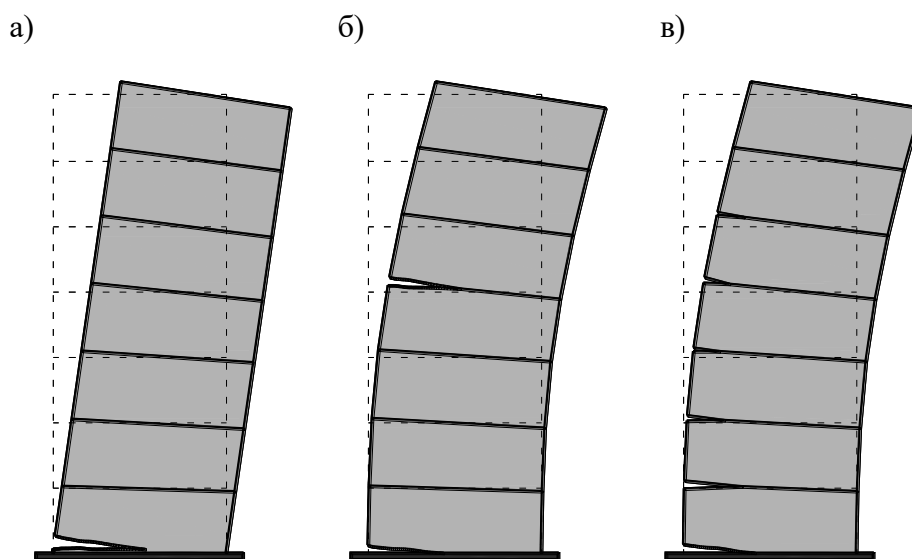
Схемы расположения зон пластического деформирования в стенах
